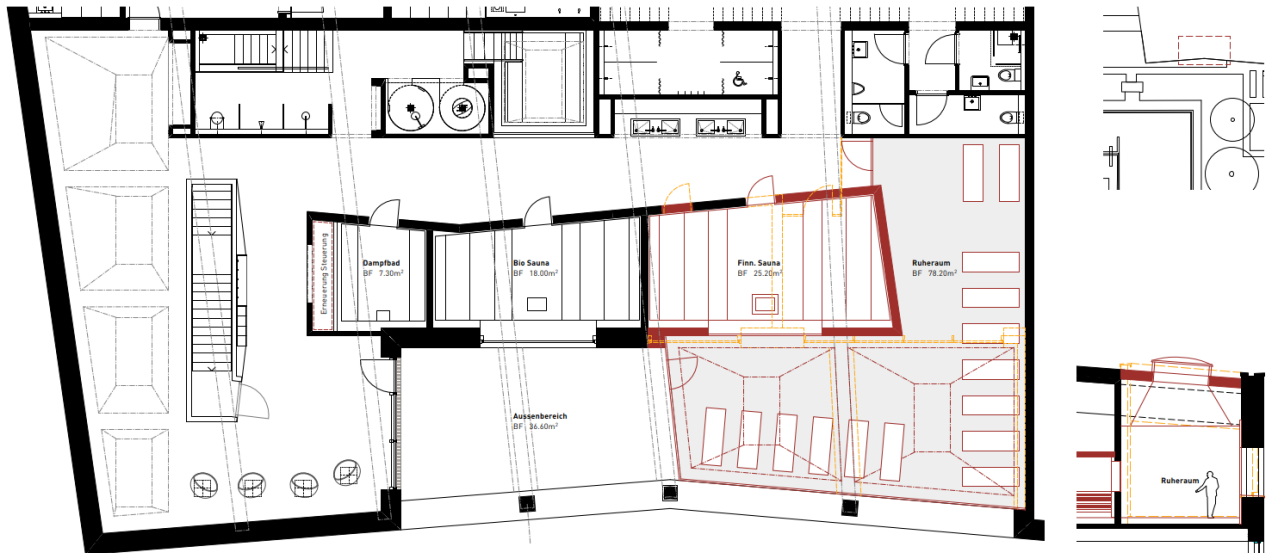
Pläne Vorprojekt Übersicht, Grundriss und Schnitt
